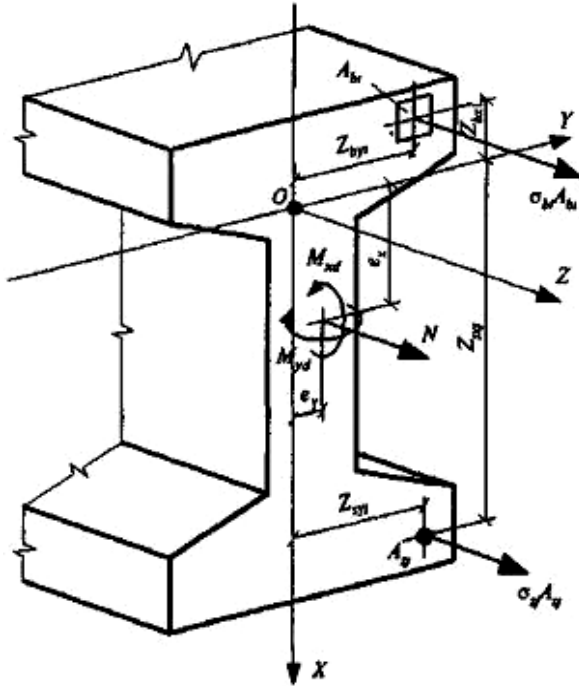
Расчетная схема нормального сечения железобетонного элемента
